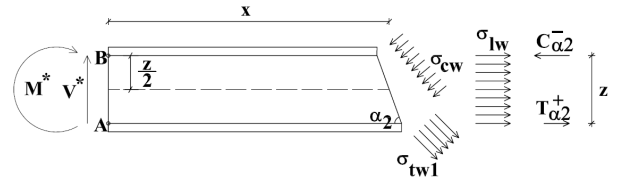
Tronco di trave, sezionato all'estremità con piano parallelo alla direzione delle staffe α_2
